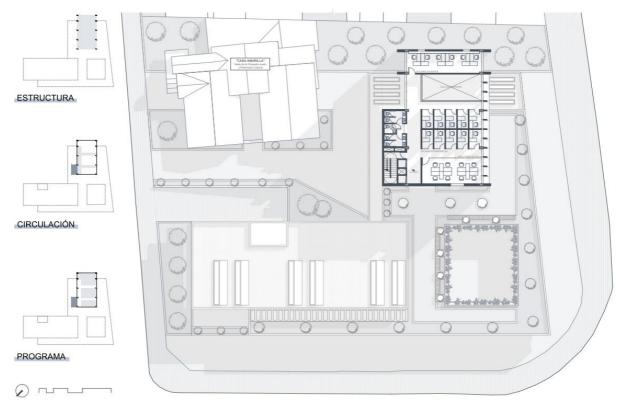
Planimetría: Planta Alta 7 (N+28,00)
